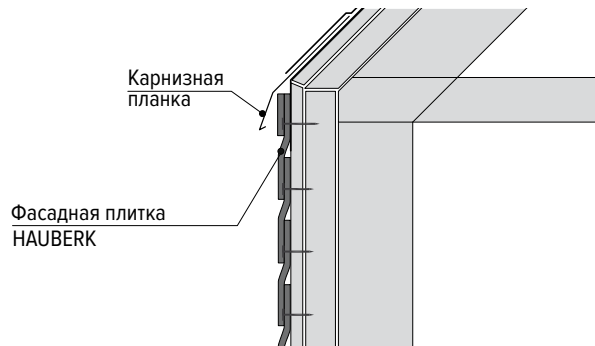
Монтаж верхнего ряда в домах без карнизного свеса
